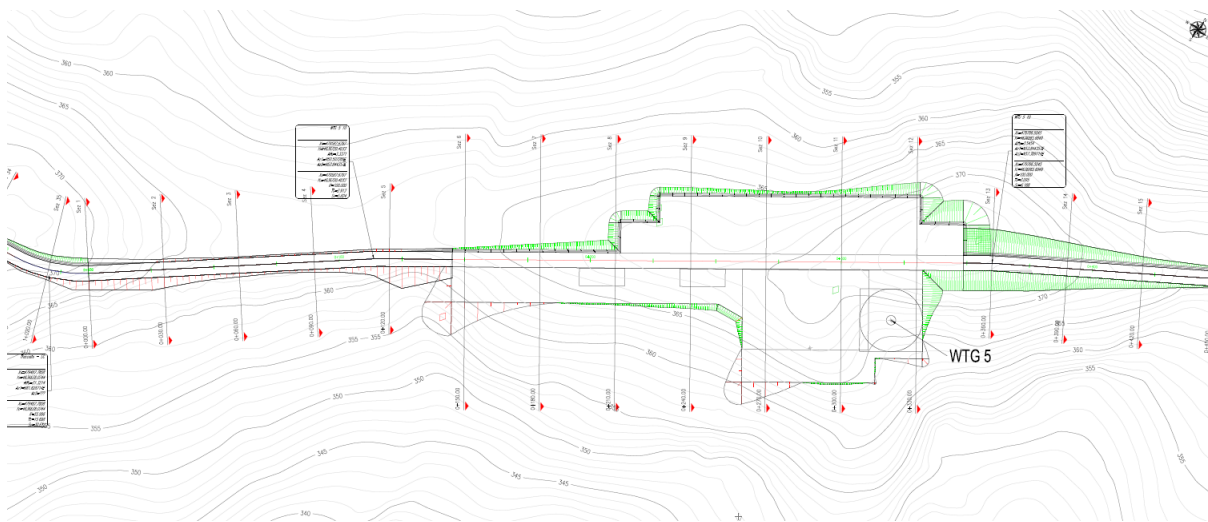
Tracciato planimetrico viabilità di nuova realizzazione. Fonte: elaborato di progetto “GRE.EEC.D.73.IT.W.15235.12.015.00_Layout strade WTG5-WTG10”
